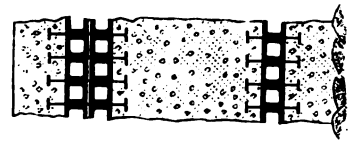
Kabelleitungen in der Betonwand eines Tunnels der New-Yorker Untergrundbahn.]
